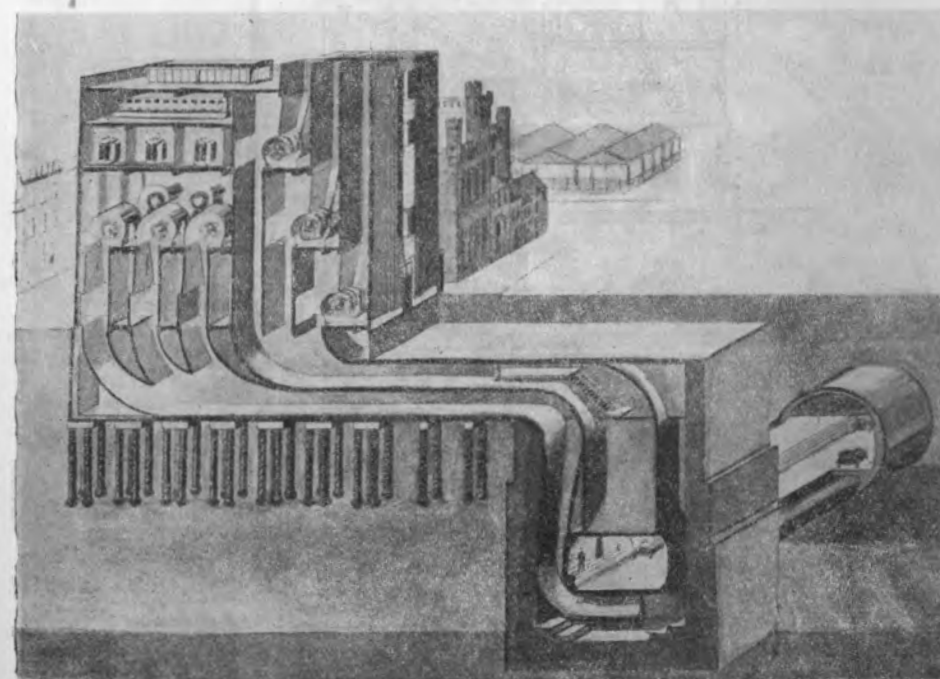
Общий схематический разрез вентиляционного здания, шахт и тоннеля для автодвижения.
